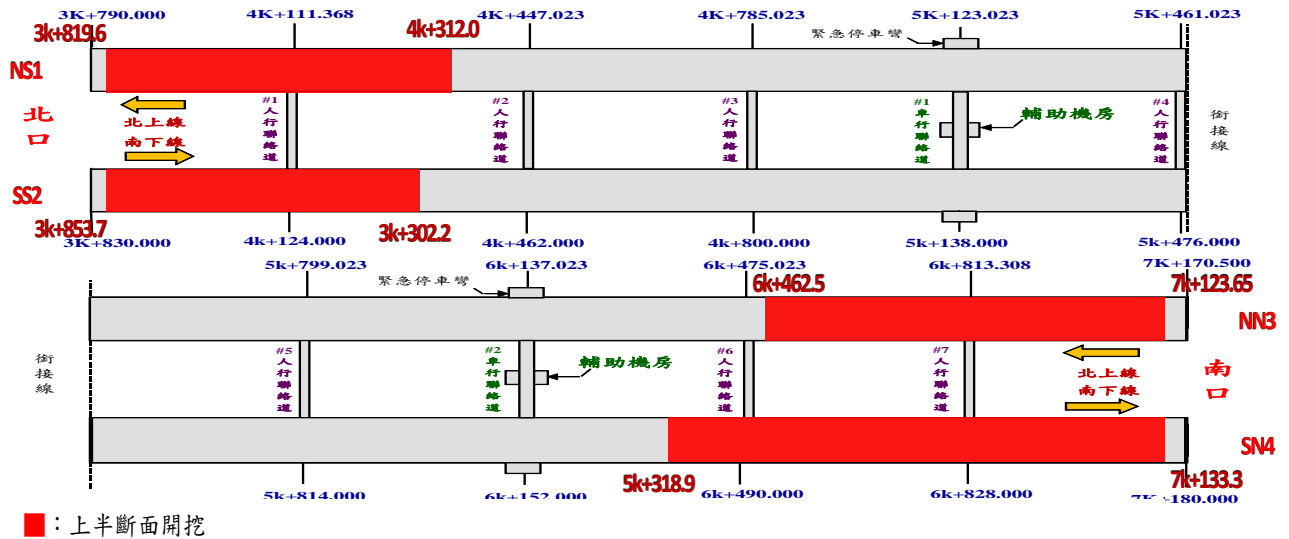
東澳隧道新建工程(A2 標) 施工進度
